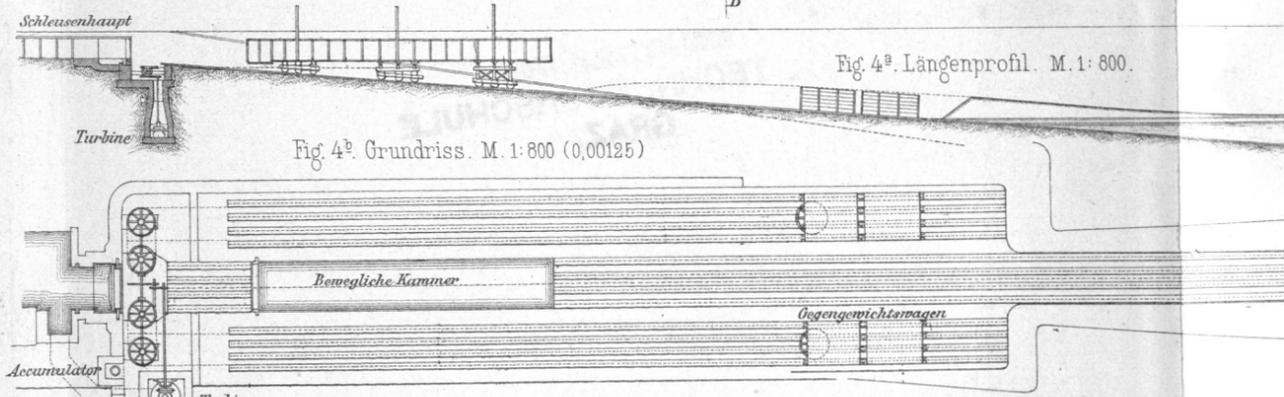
^b Grundriss. M. 1:800 (0,00125)
